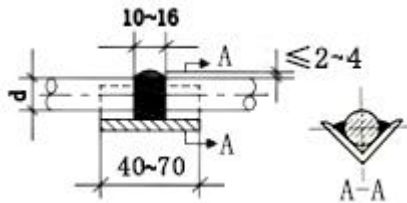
钢筋熔槽帮条焊接头
